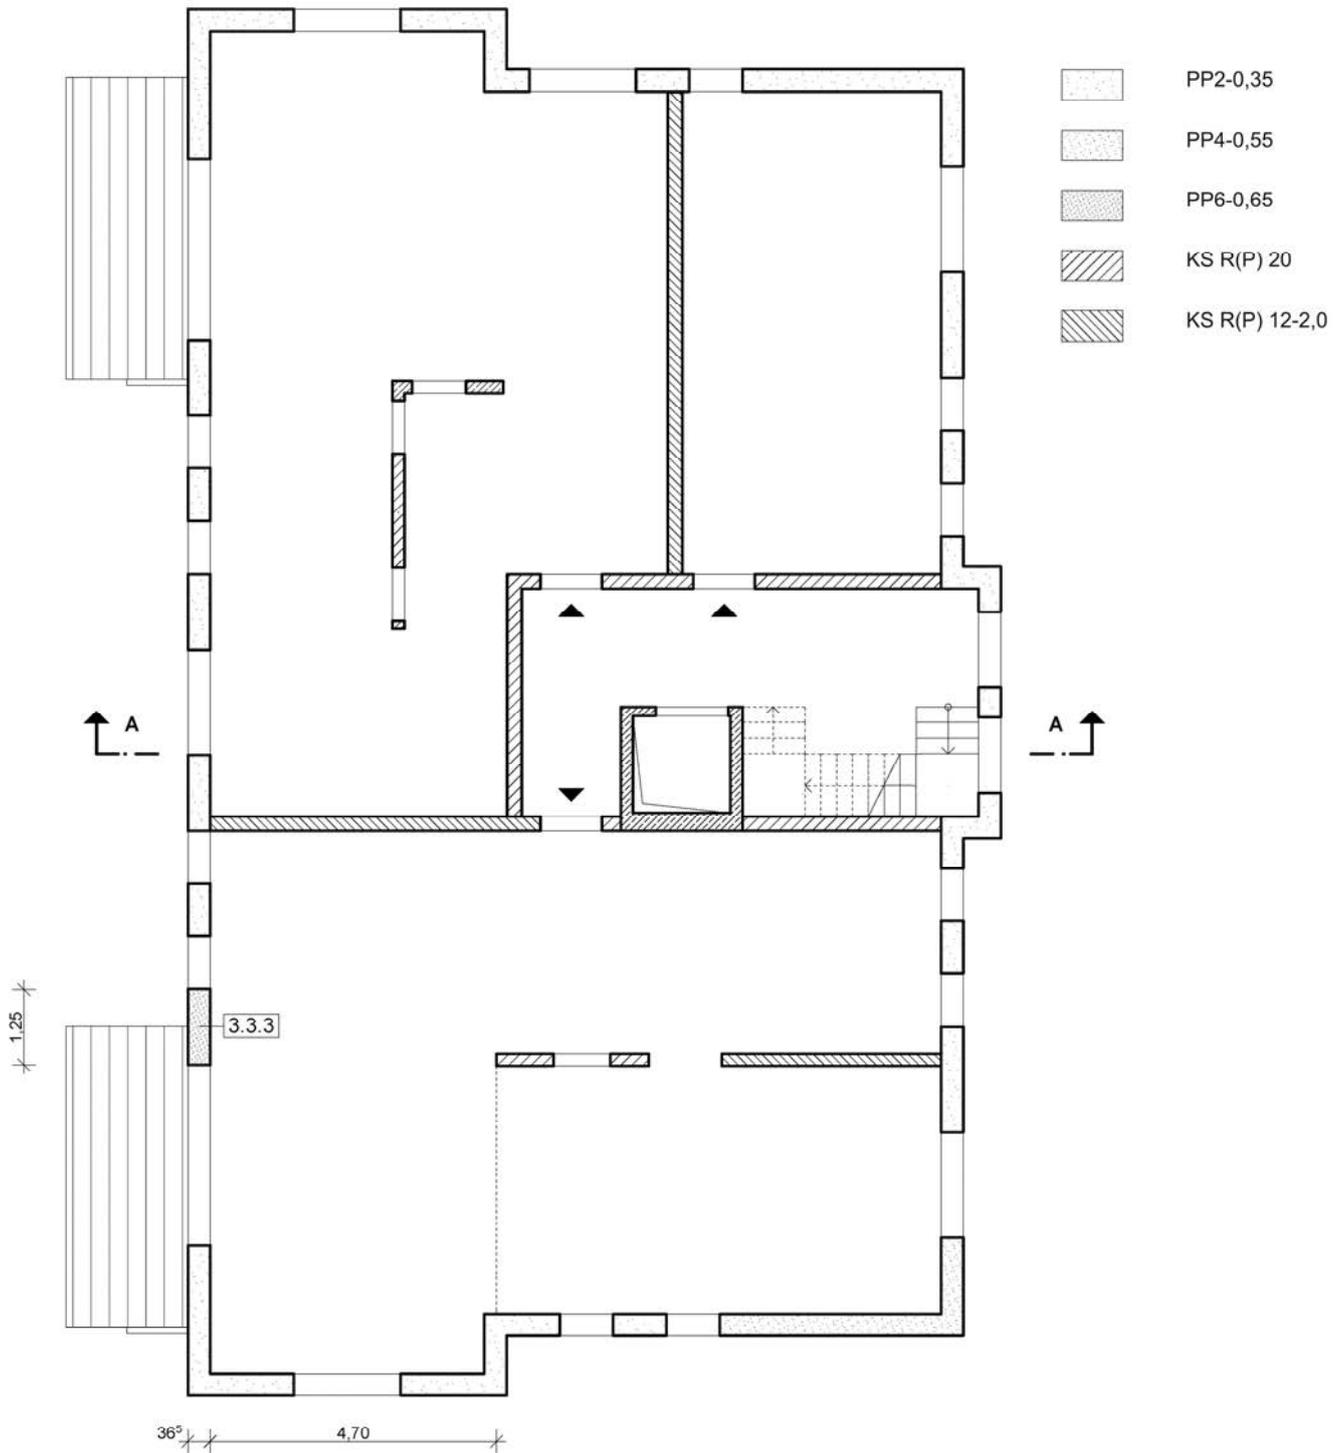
Mehrfamilienhaus in Dresden, Grundriss 1. – 3. Obergeschoss
